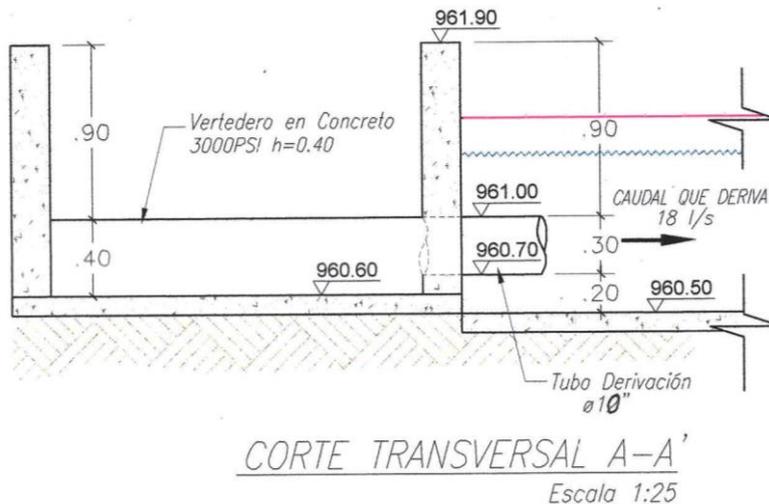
Detalles de la obra de captación, vista en corte transversal.
